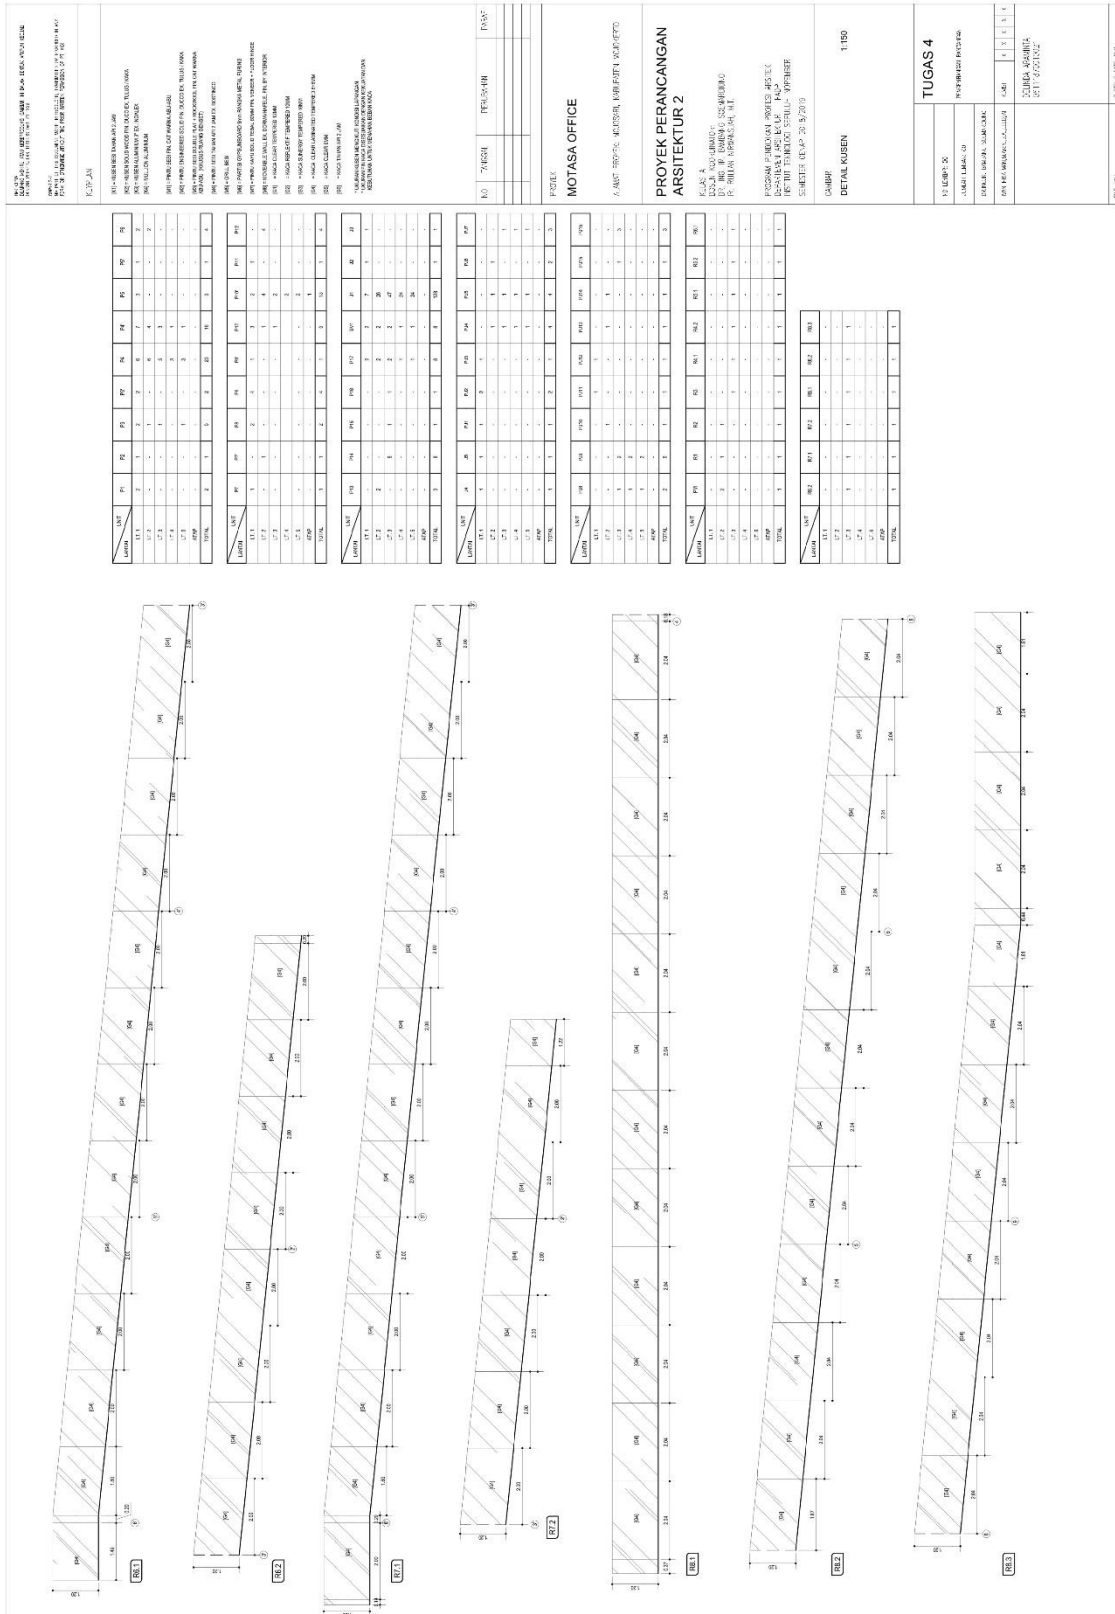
Rencana kusen & railing lantai 1
